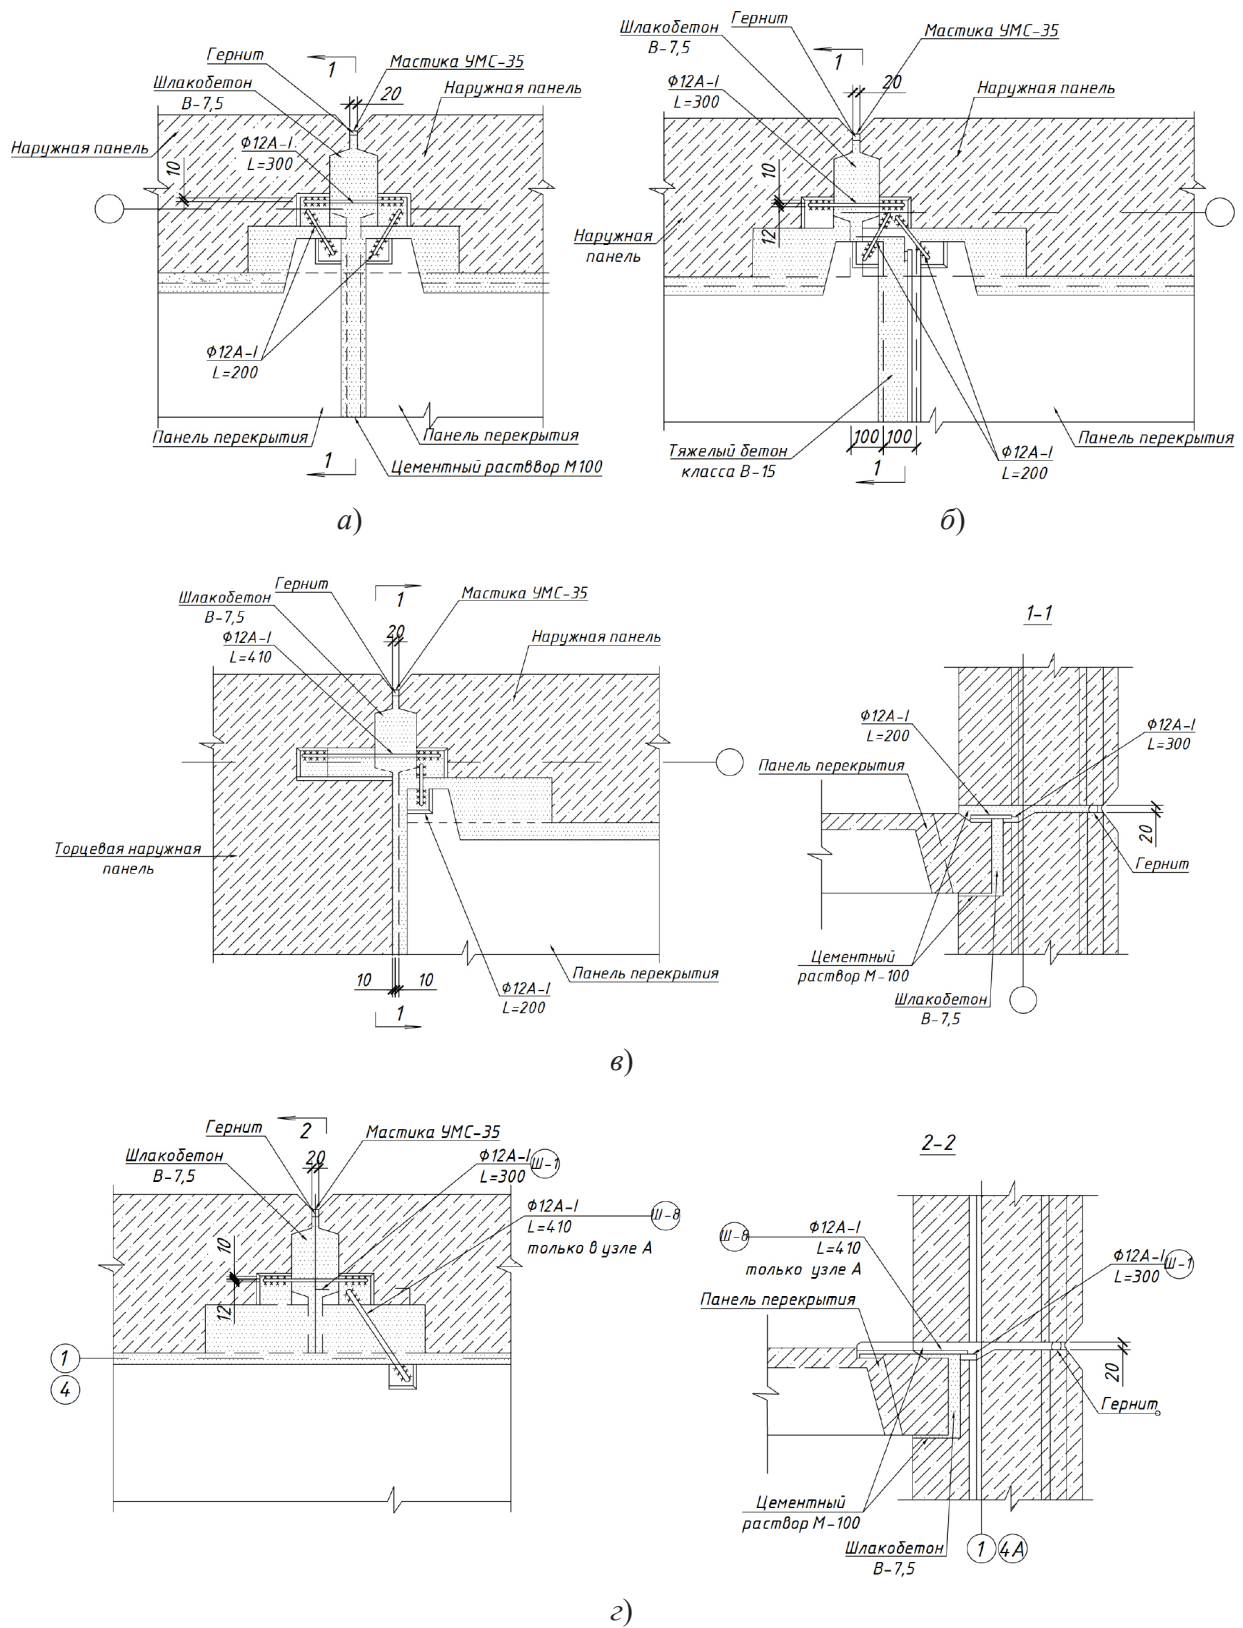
Стыки: а – рядовых наружных панелей и плит перекрытия; б – наружных панелей и плит перекрытия; в – торцевых наружных панелей и плит перекрытия; г – наружных рядовых панелей и плит перекрытия
